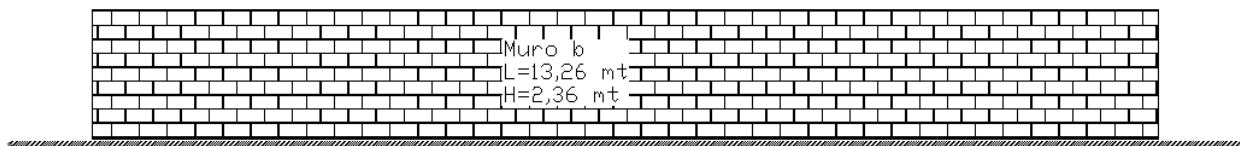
34. Muro Central Eje Y, edificio 4 pisos
